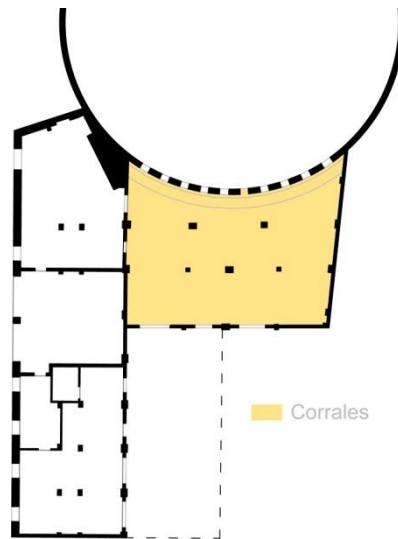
Zona actuación interior de Corrales. Fuente: Propia autora.
